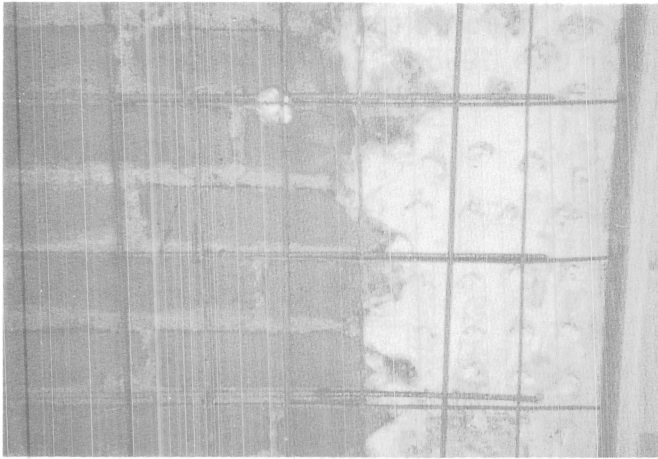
Confinamiento de un castillo con mallas metálicas que han sido traslapadas.
